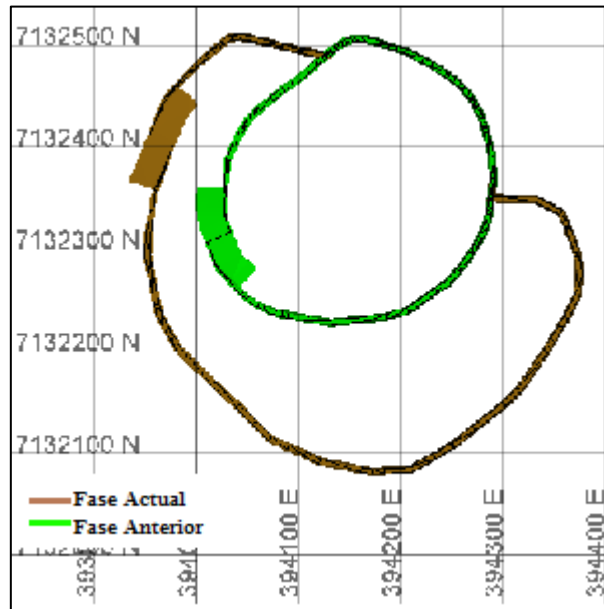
LGMM2Y Fase 2 - Vista en sección - Planta banco 1080
